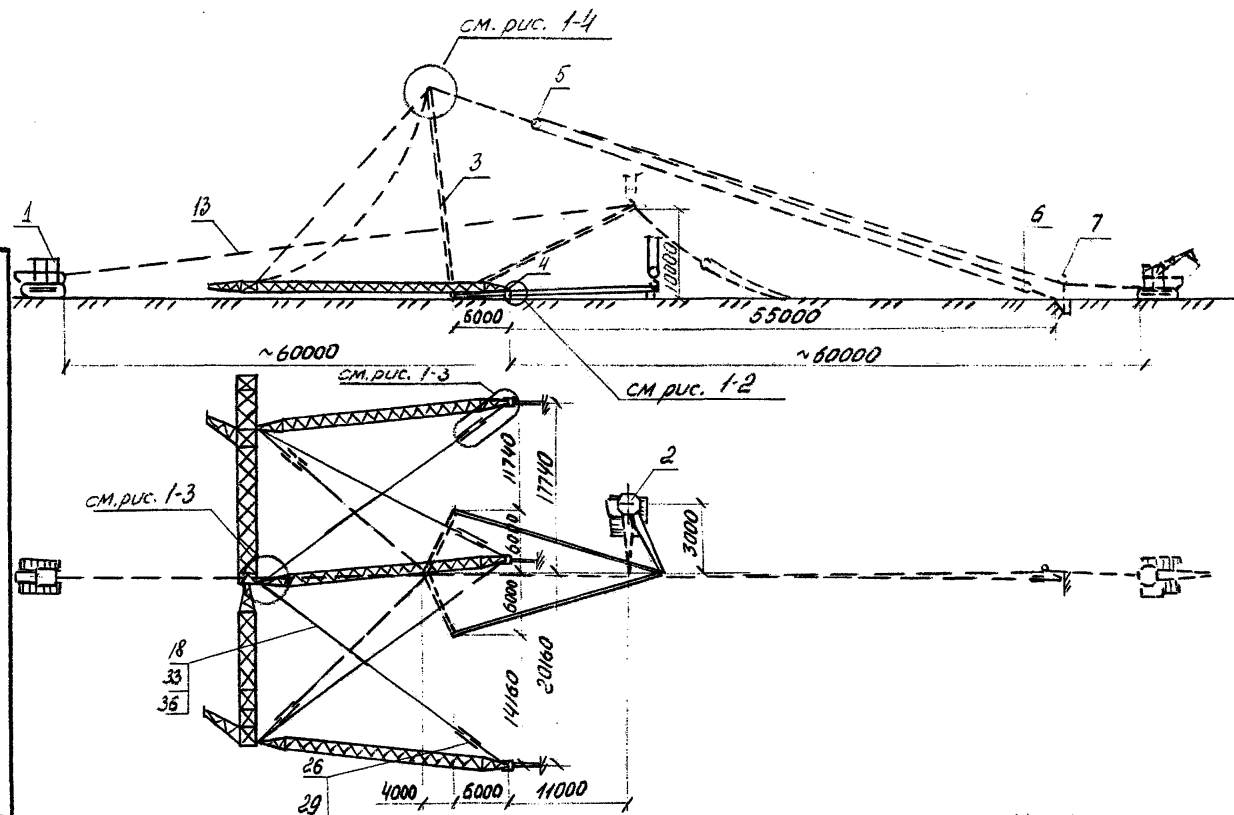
Схема подвеса А-образной монтажной стрелы Н=22м
